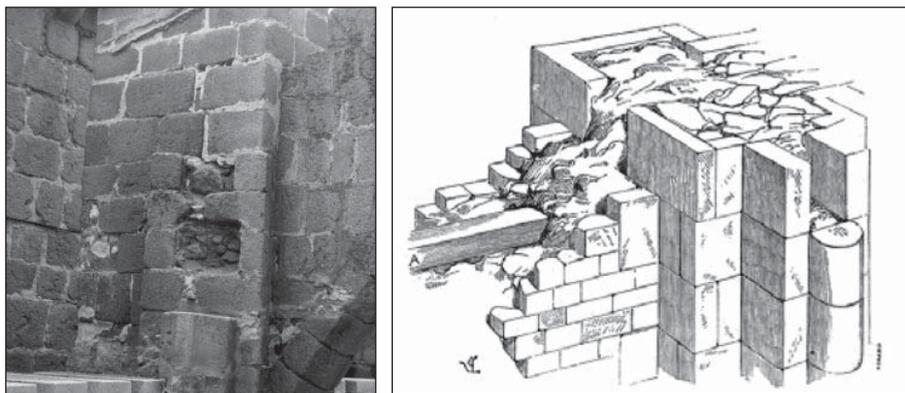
Detalle la construcción de un muro situado en el cimorro, dibujo de *emplectum* románico (Viollet-le-Duc, 1858-68).
